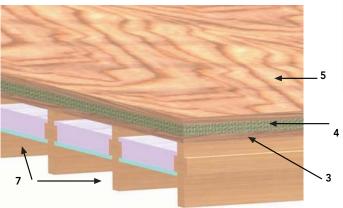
Vigas de Pino radiata estructural de 2"x10" para el entramado a la vista.
